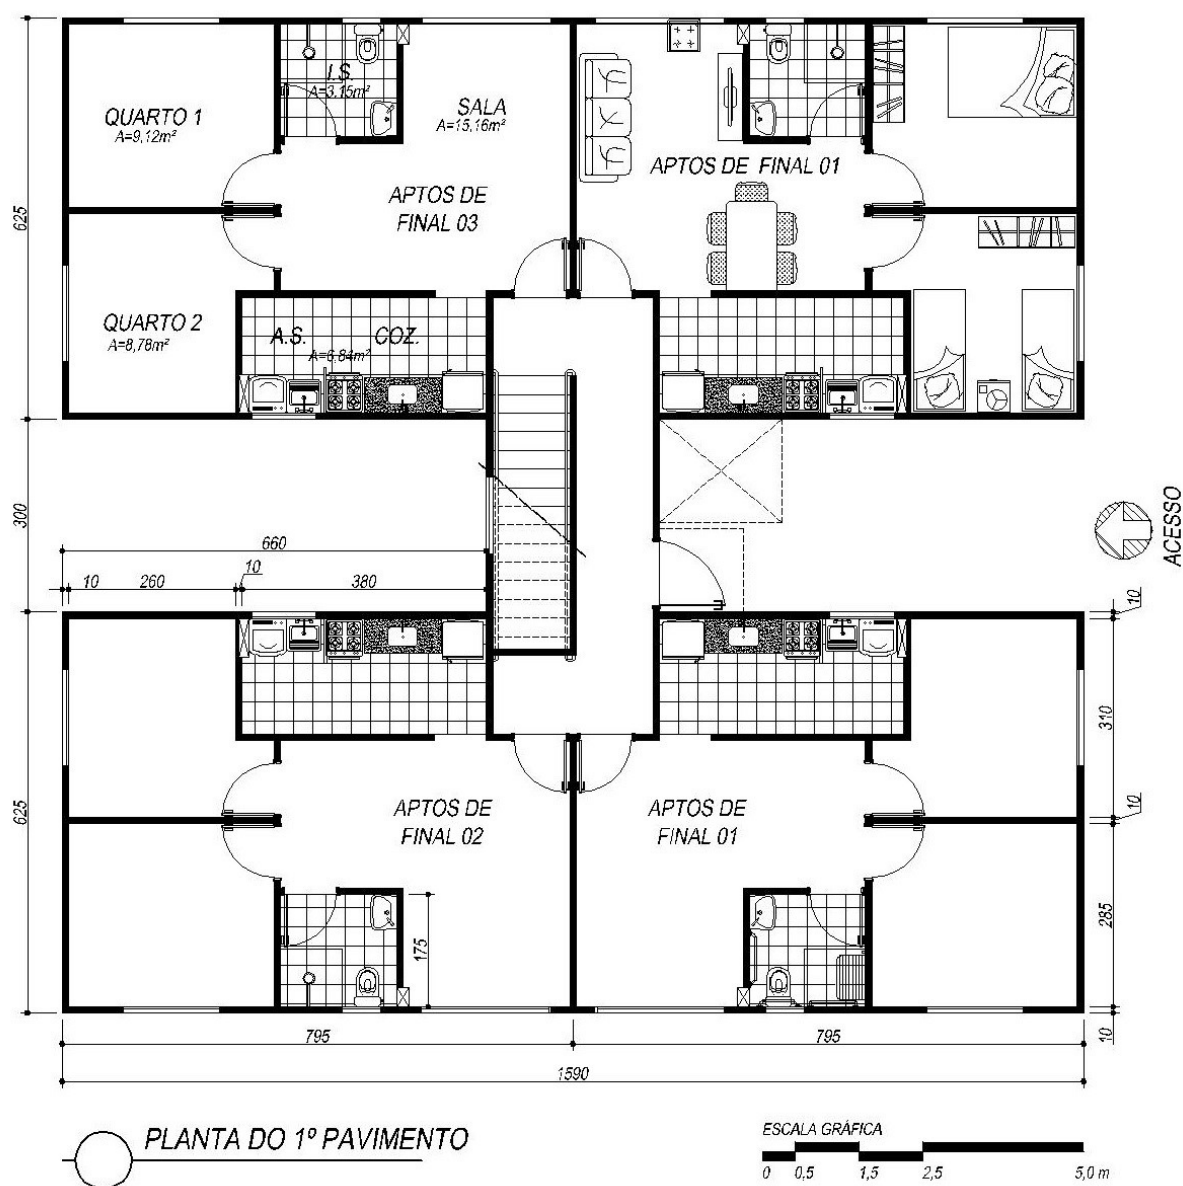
Planta do pavimento térreo do Residencial Tocantins. Fonte: Projeto Arquitetônico Tocantins 1 -SEPLAN nº 4840/2014. Adaptado do original.
